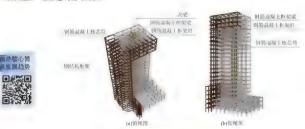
5 钢筋 目凝土框架核芯筒体结构建筑、维示意图
